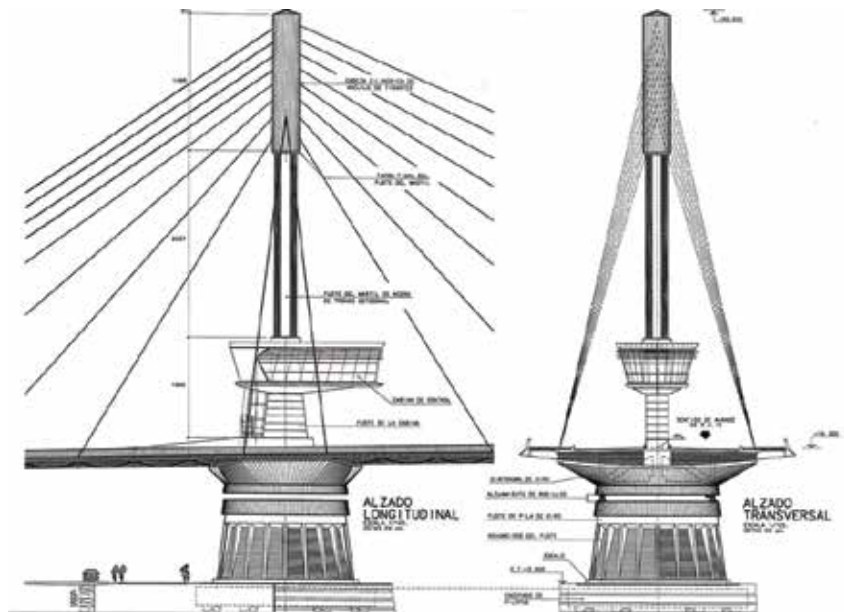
Plano del pilono de atirantamiento del Puente giratorio de Lutxana
